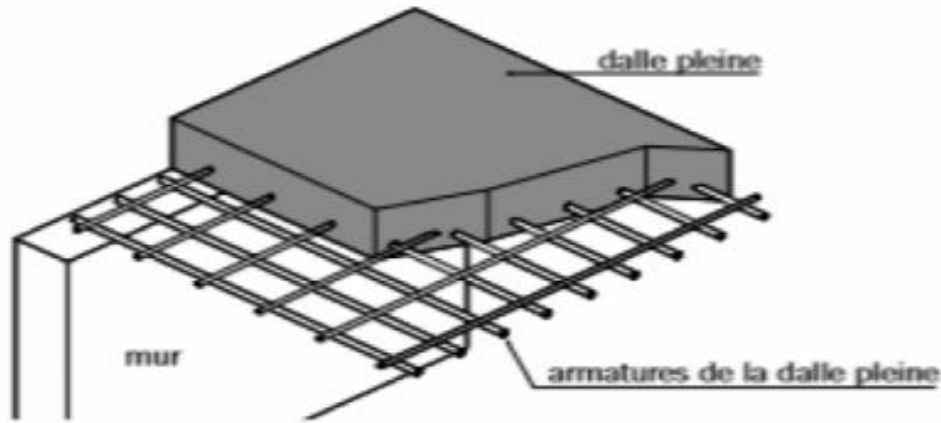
Élément d'un plancher en dalle pleine
